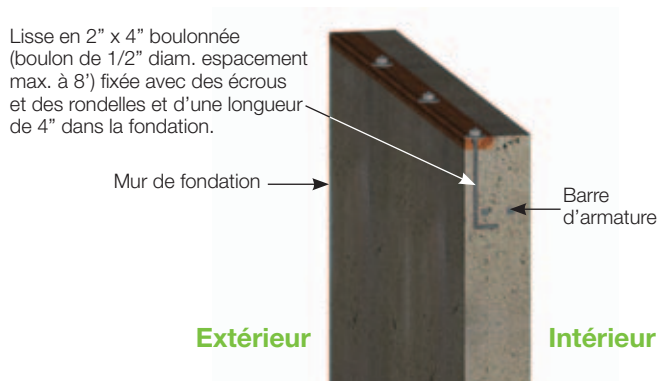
• Détail type d'un ancrage sur fondation standard
